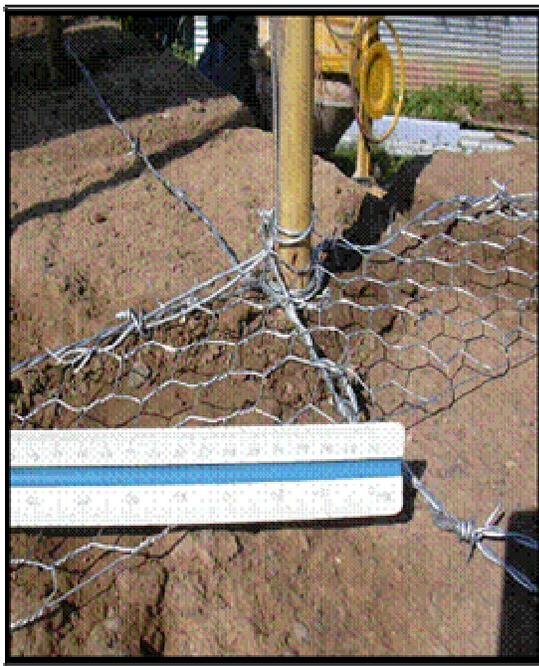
Colocación del Refuerzo de Caña en El Salvador (Dowling, 2002)
